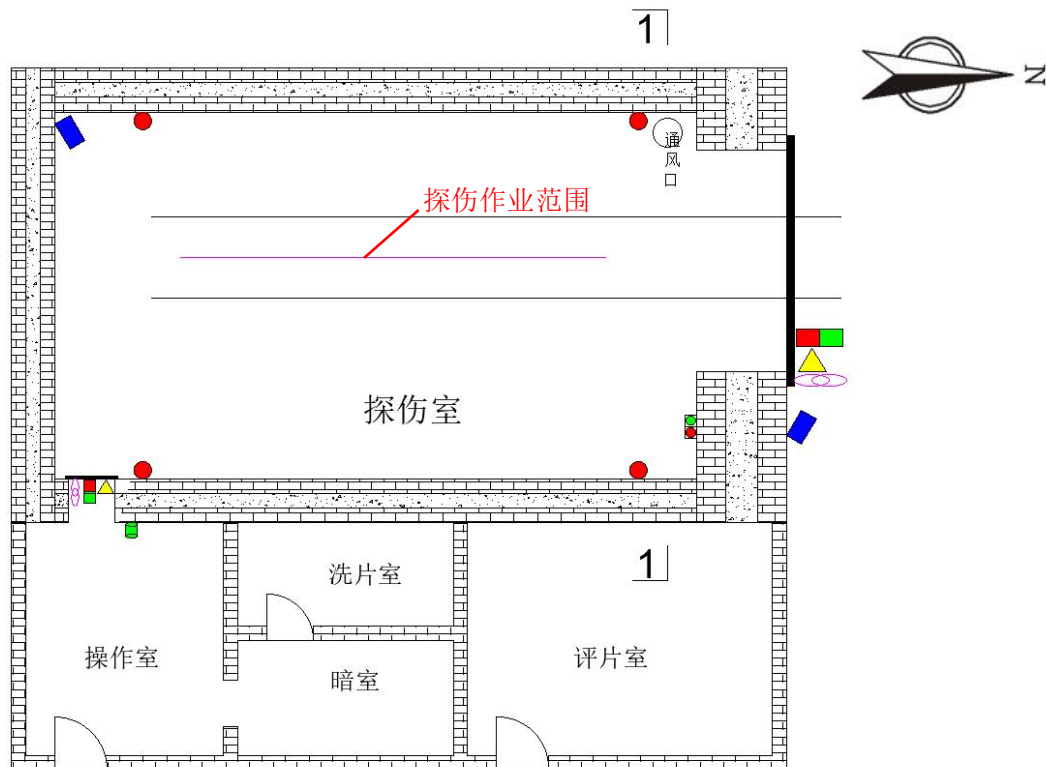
(a) X射线探伤机在探伤室内探伤作业范围示意图（平面图）
